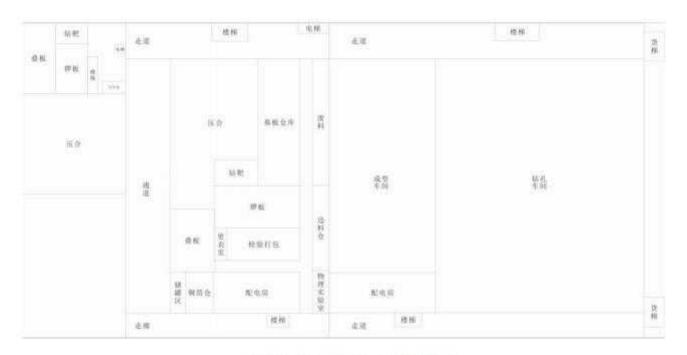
项目厂房 2.3.4 一层平面布置图
